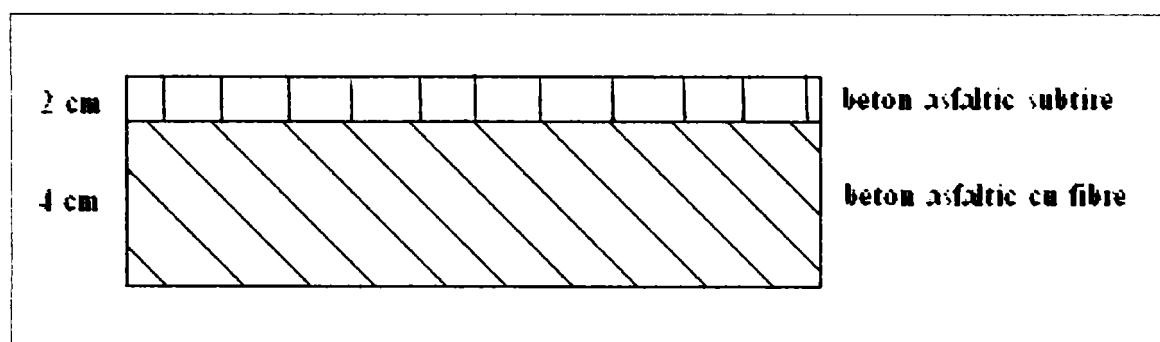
Sistem bistrat din beton asfaltic cu fibre și beton asfaltic subțire
